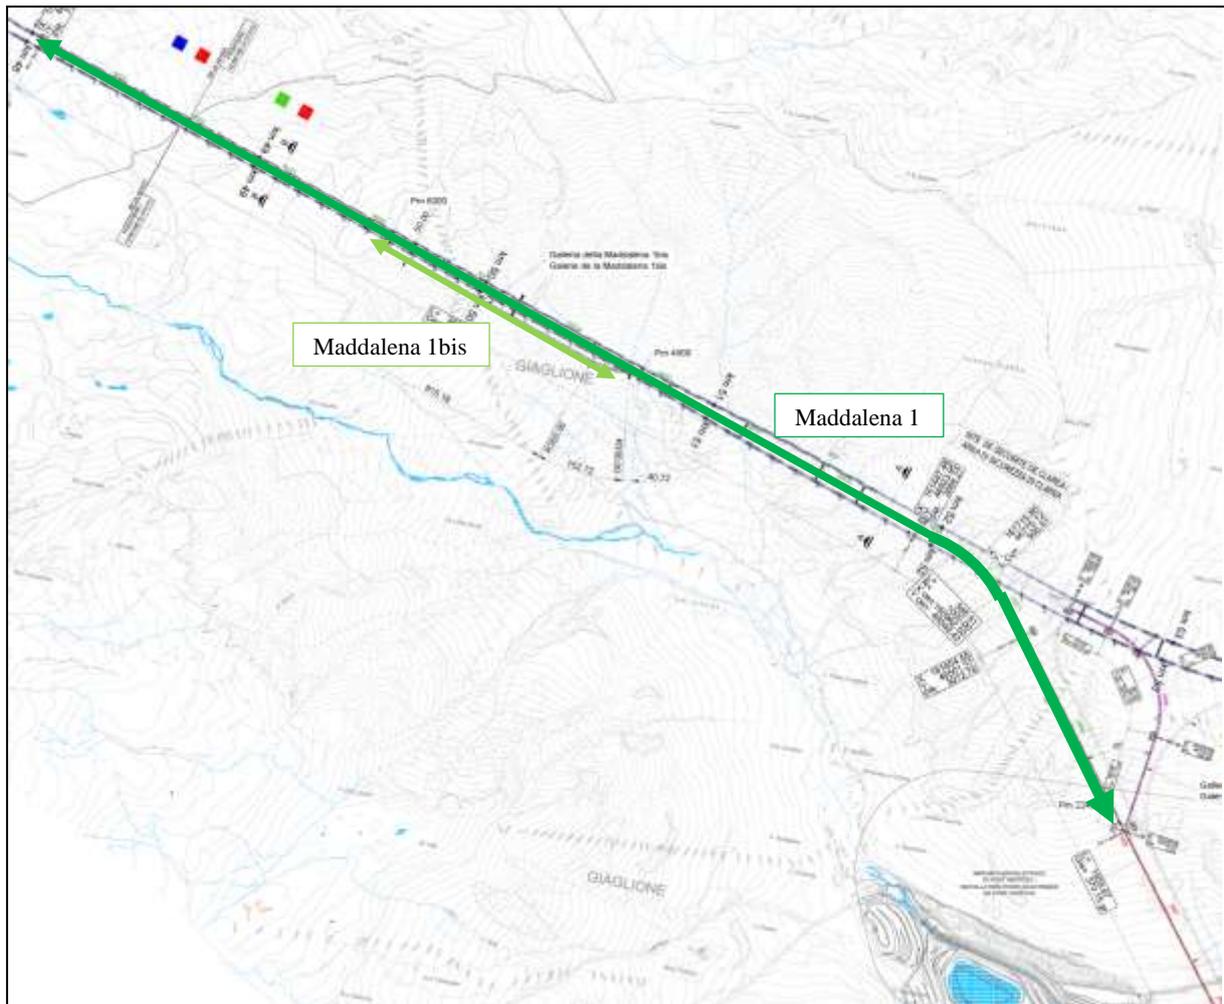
Planimetria delle zone di stoccaggio in Maddalena 1 e Maddalena 1bis (PRV_C3A_3803_26-48-10)
